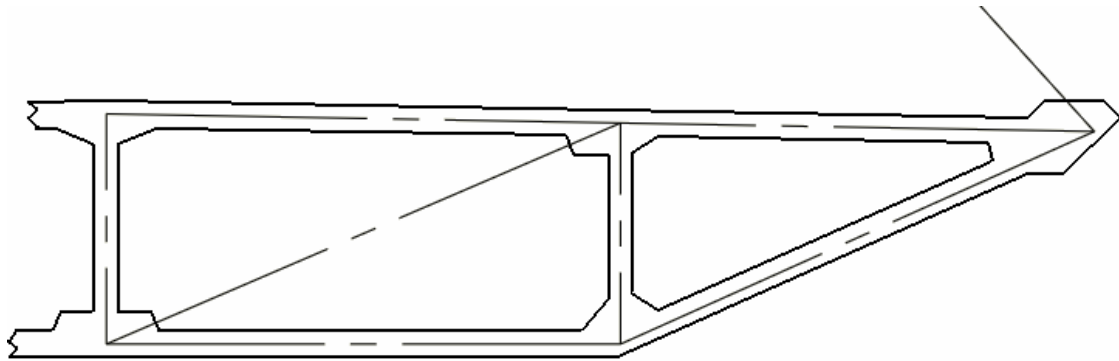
Sección transversal del tablero en su unión con la cimentación.
